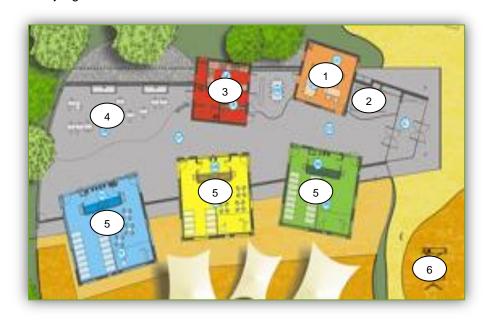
Planta arquitectónica, Guardería "Els Daus". Fuente y Elaboración: AIA Salazar-Navarro
